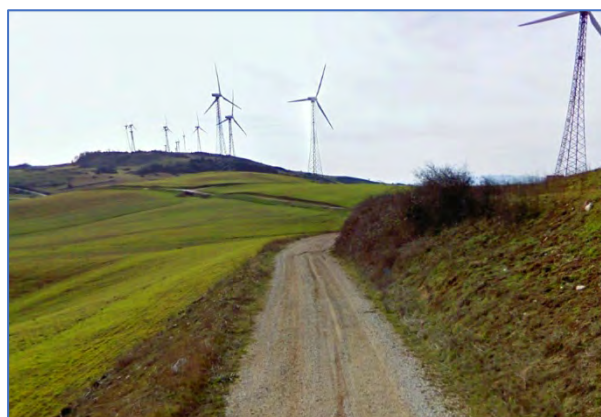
stradina di collegamento tra BAS02 e BAS03, vista da nord
